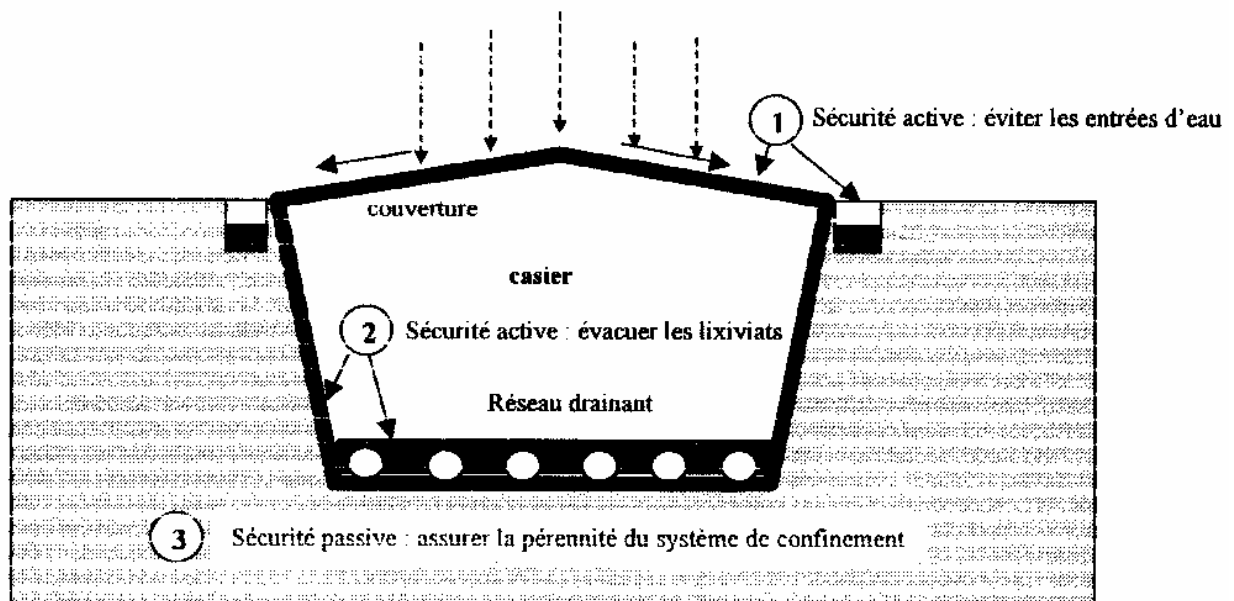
Coupe schématique d'un CSD, avec son dispositif d'étanchéité- drainage
